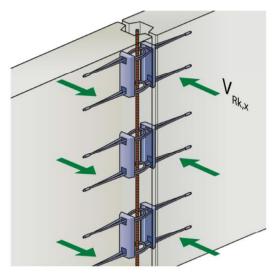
Beanspruchung unter Querlast 90° (senkrecht zu Fugenlängsrichtung und Wandebene
